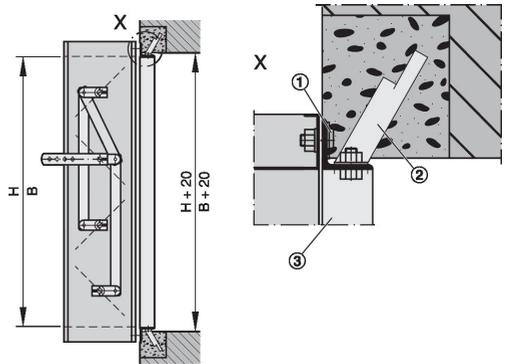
Wandanbau mit Einbaurahmen (Stahl-/
